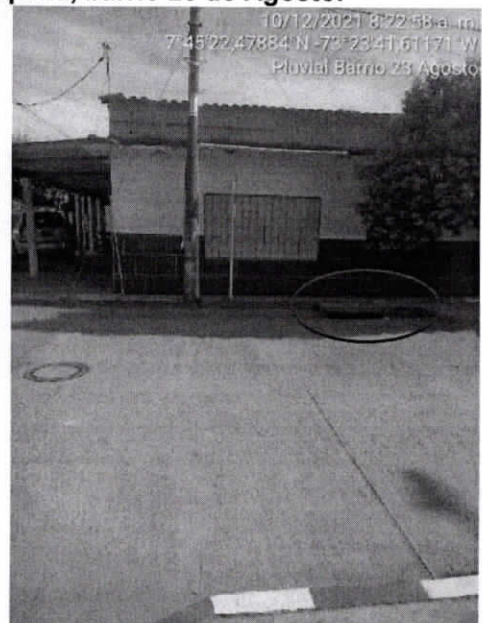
Alcantarillado Pluvial Crr 9 con calle 3, barrio 23 de Agosto.
